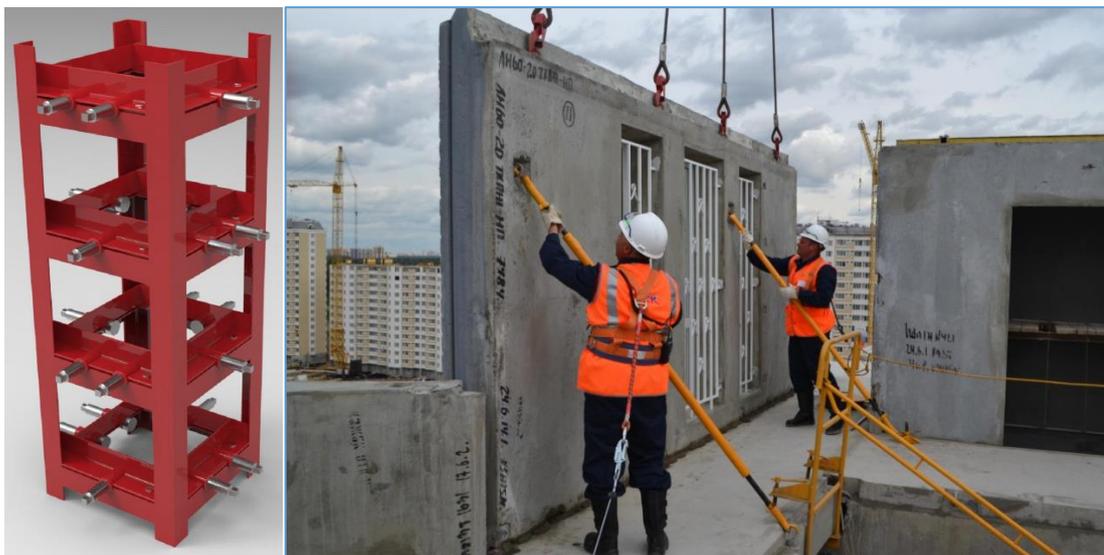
Приспособления для выверки и временного закрепления конструкций
